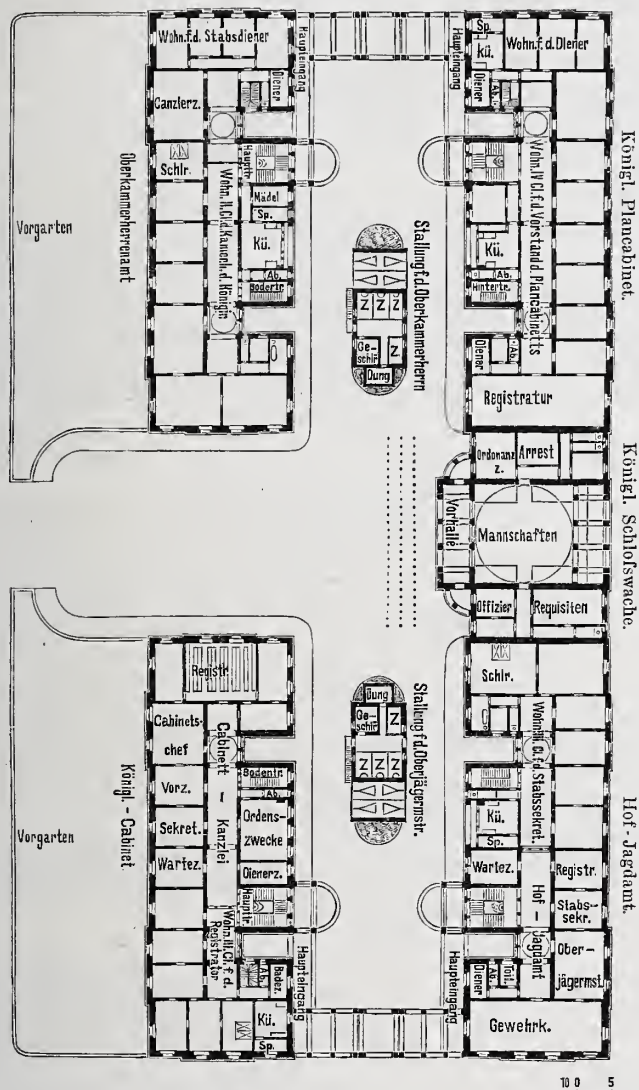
Erdgeschoss. Gruppe nach der Planie hin.
